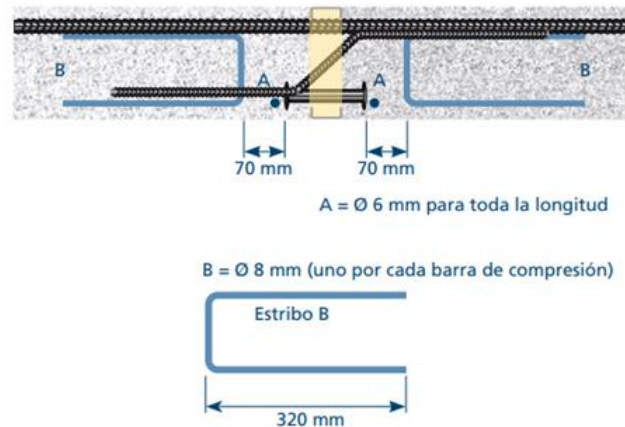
Esquema del sistema Isotec sin representación de las armaduras estructurales
